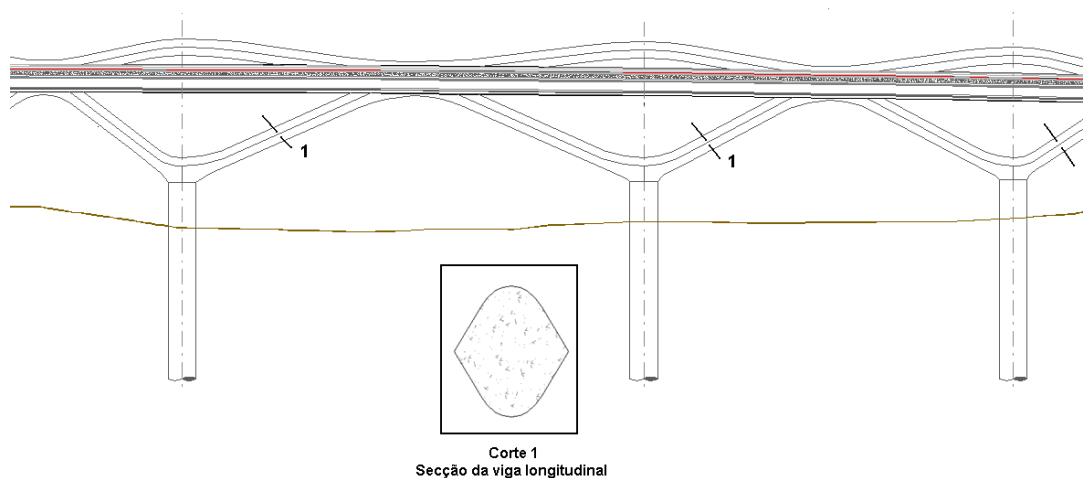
Perfil longitudinal da nova ponte (esquemático, com identificação da secção da viga longitudinal)
